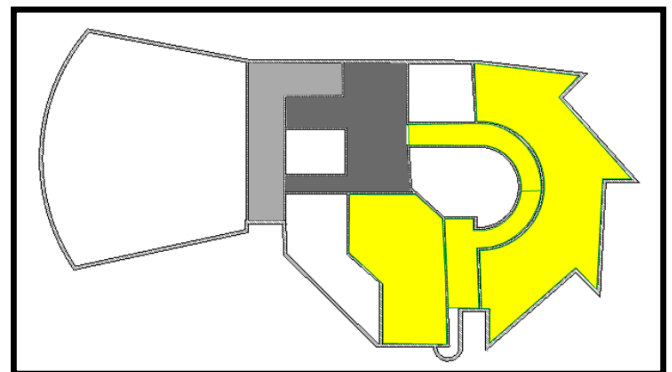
Plan du 1er étage avec éclairage Source ; auteur
